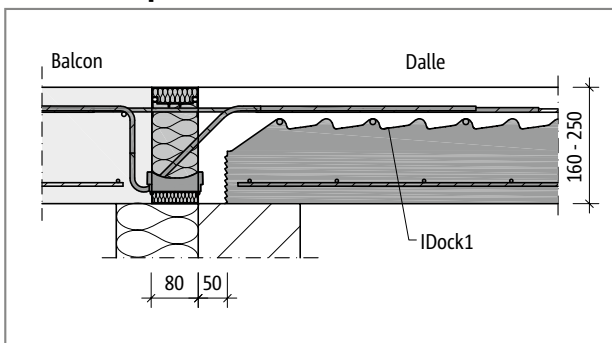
Schöck Isokorb® T Type K-E : Raccordement de balcons avec des épaisseurs de panneaux de 160 mm à 250 mm avec IDock1
